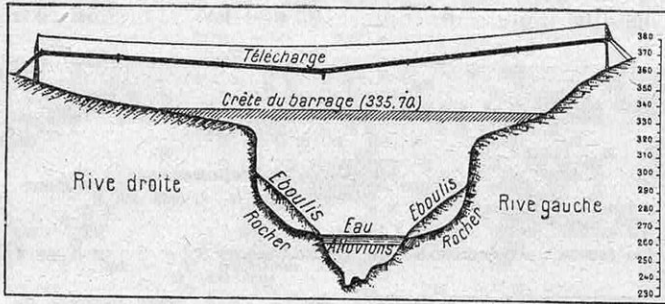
COUPE TRANSVERSALE DU SITE DE GÉNISSIAT
